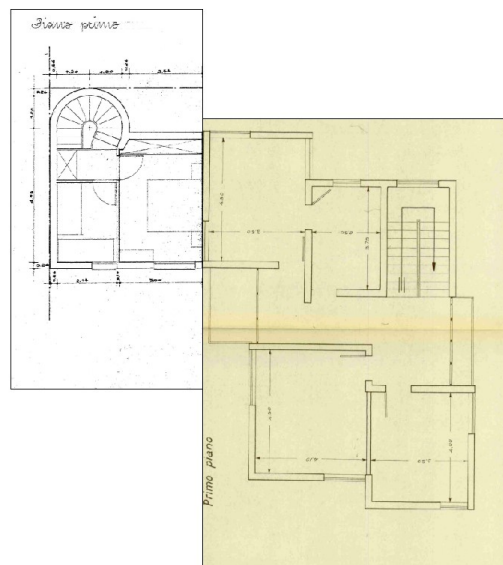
affiancamento del progetto originario con il progetto dell'ampliamento – piano primo
